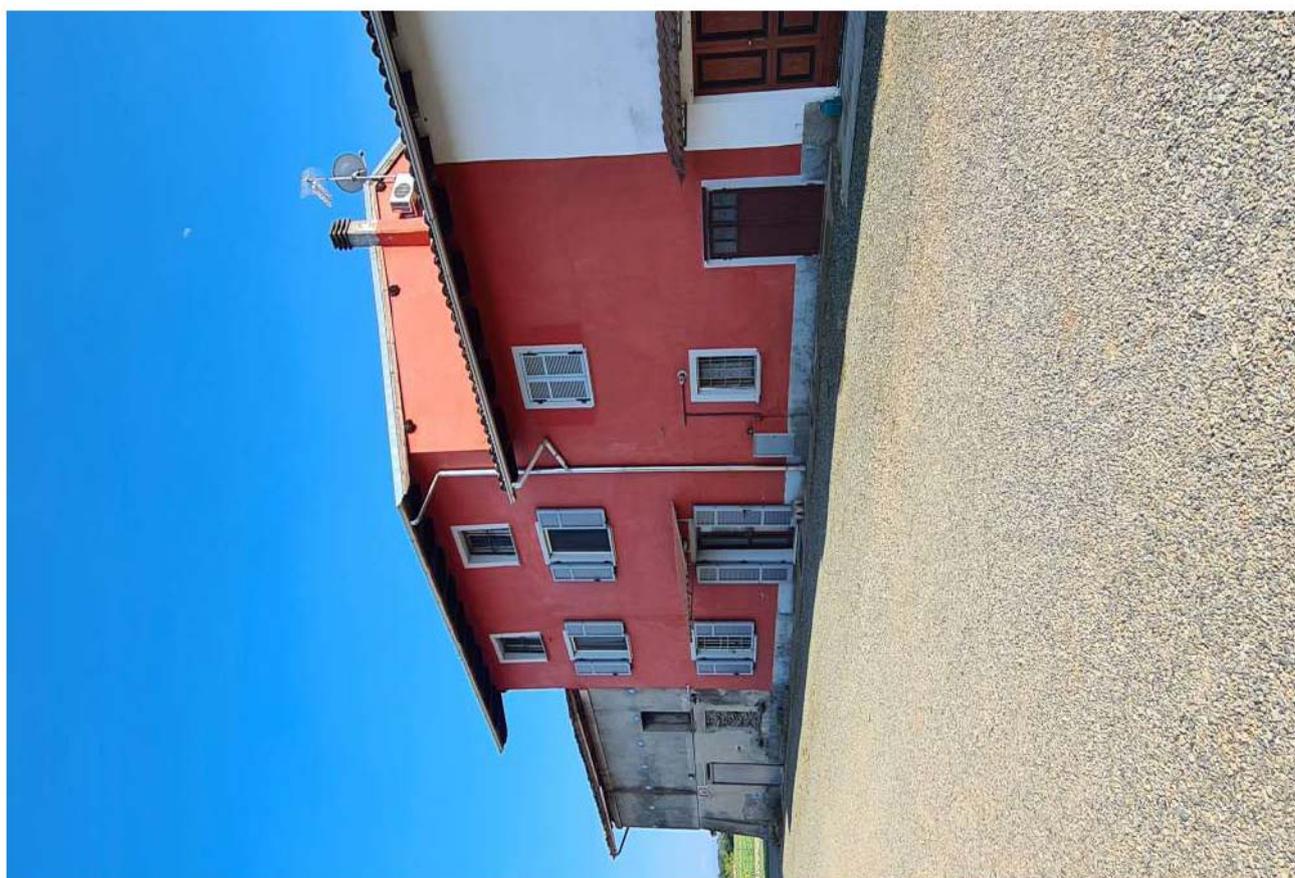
prospetto sud (casa tinteggiata in colore amaranto)
